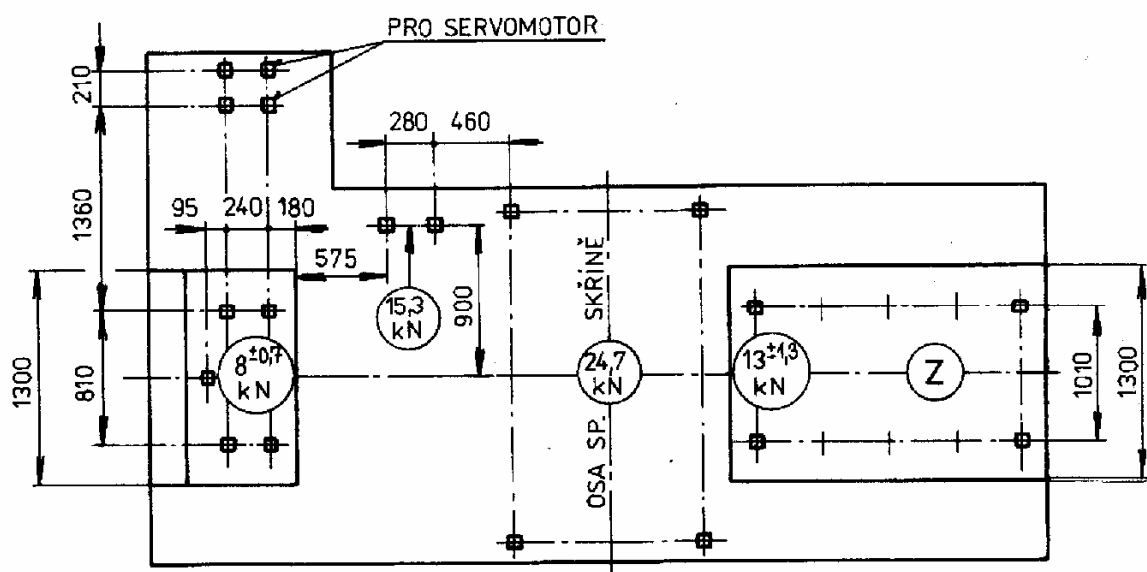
ROZMĚRY ZÁKLADŮ RSI 1600
